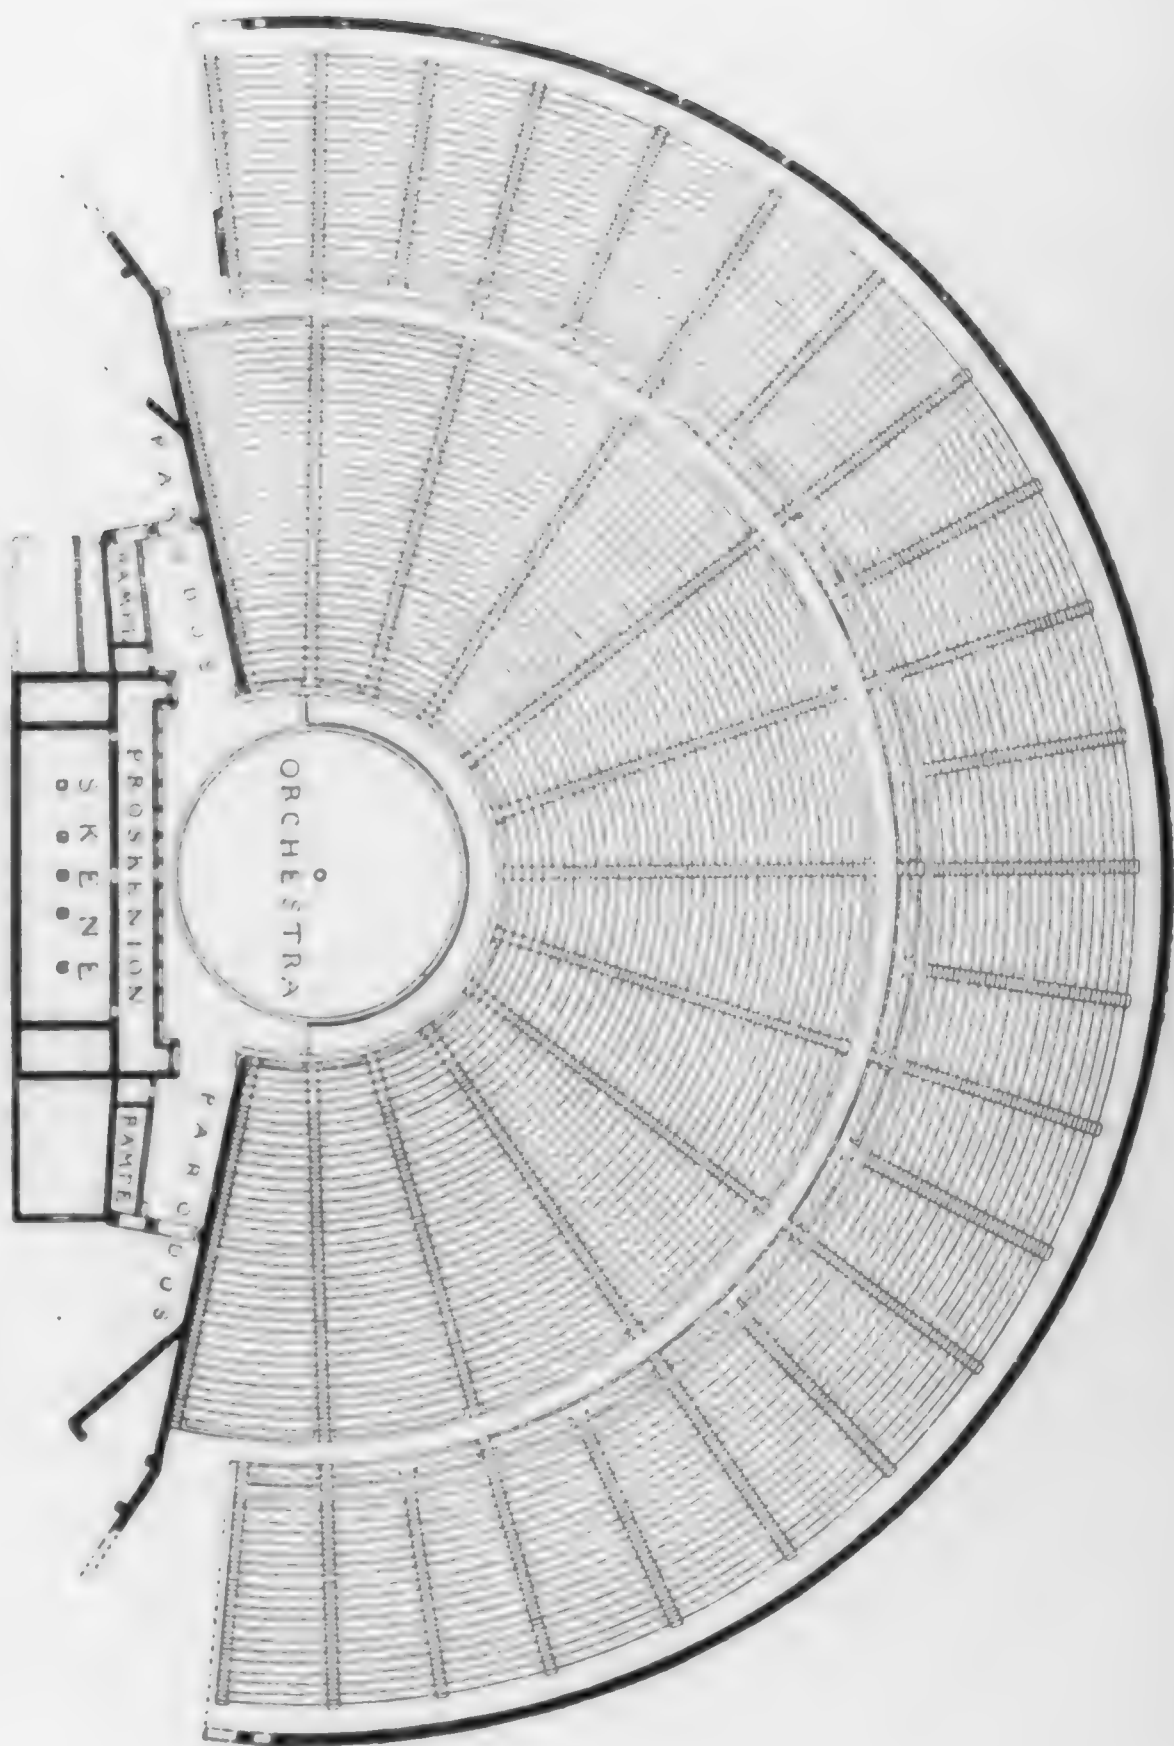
Grundriss des Theaters in Epidauros. (Ergänzt.)
